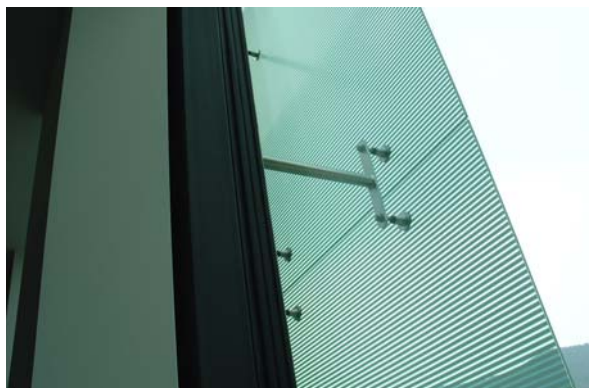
Schermatura vista dall'interno. Figura A1.14 : Schermatura vista dall'esterno.
